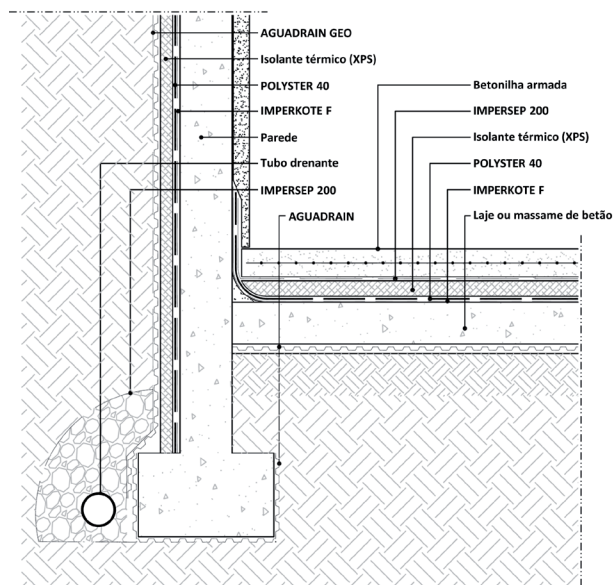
Aplicação dos sistemas em paredes e pavimentos em contacto com o terreno
